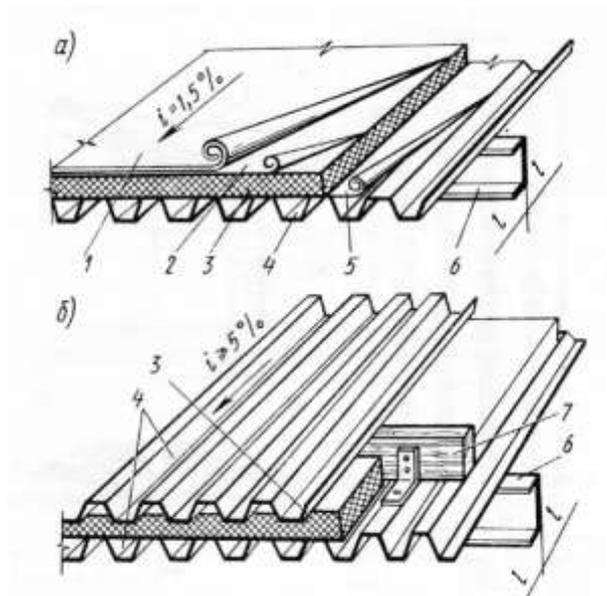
Ограждающая конструкция покрытия в отапливаемых зданиях:
